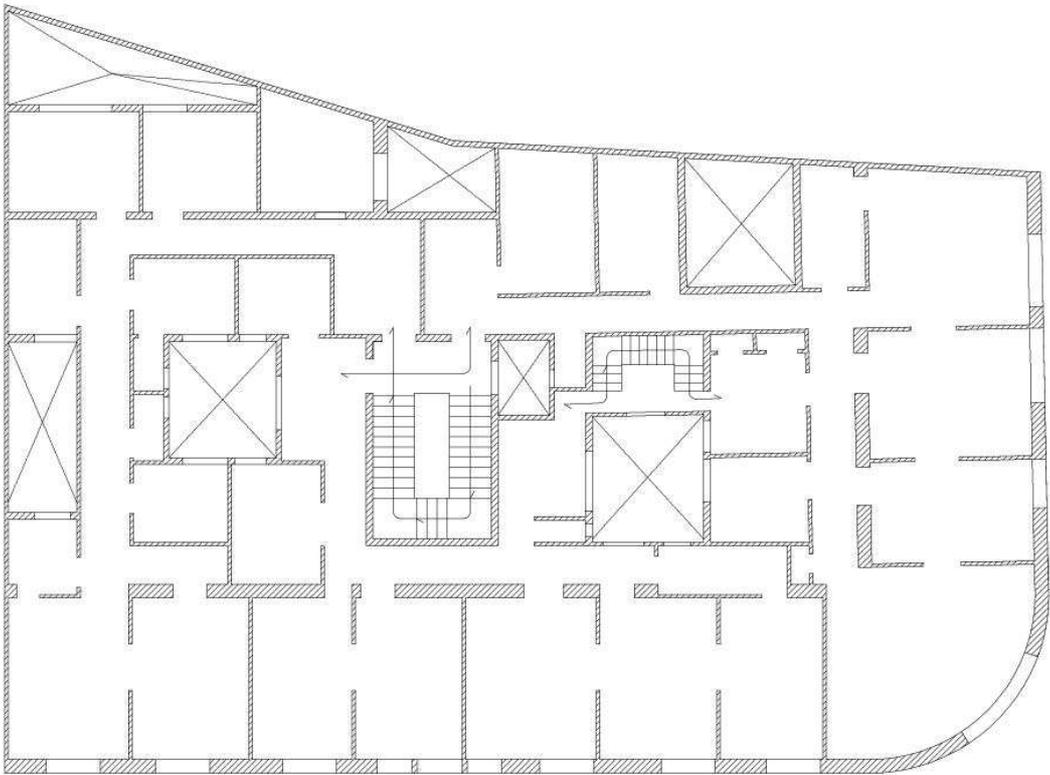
Levantamiento CAD Plantas 1,2 y 3 Edificio Niederleytner. Fuente: Elaboración propia.
